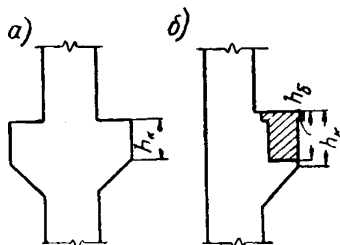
Консоли колонн для опирания подкрановых балок; а — сборных; б — монолитных
